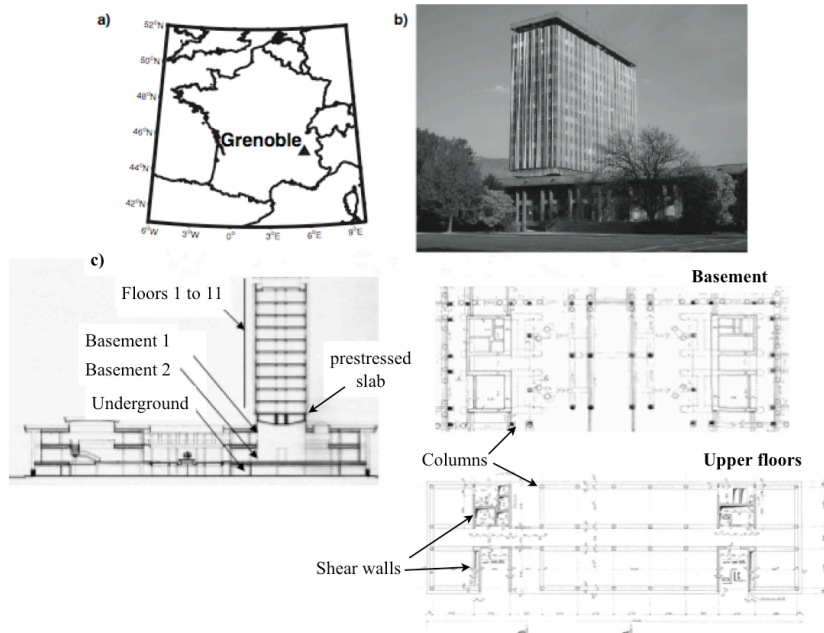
a) Localisation de Grenoble en France. b) L'Hôtel de Ville de Grenoble, vue depuis le Sud-Est. c) Coupe et vue en plan d'un étage courant de la structure principale de l'Hôtel de Ville (d'après [255]).
